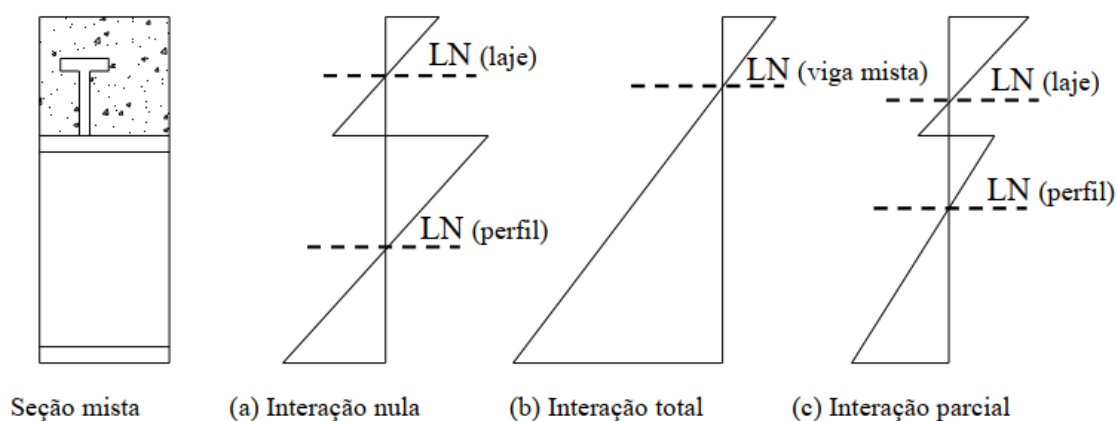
Distribuição das tensões para uma estrutura mista. (Fonte: Cavalcante (2010))
